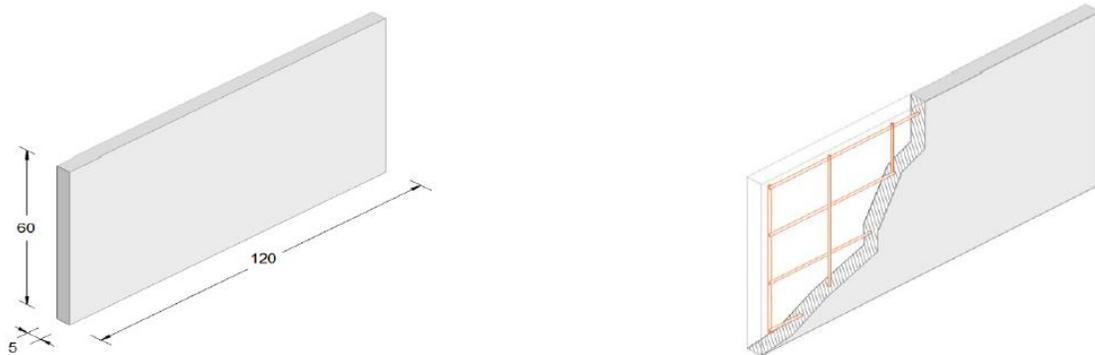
Paneles de Revestimiento de Concreto Celular / Imagen de las fichas técnicas AICRET SMKT
